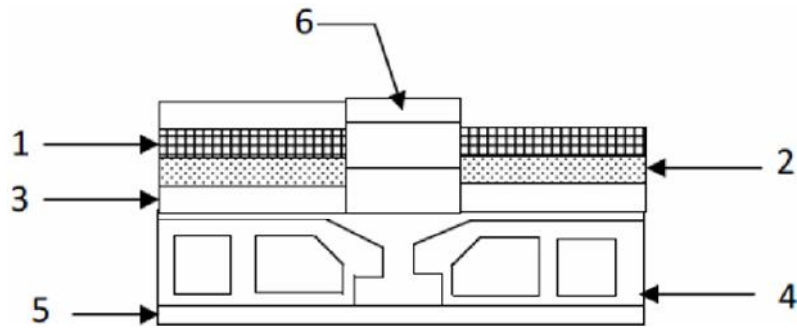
Coupe transversale du plancher d'étage courant.
